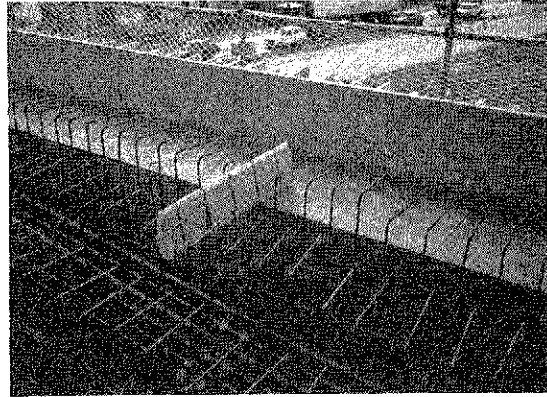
Detalle de una de las cuñas de losa inferior en la 1.ª fase de hormigonado.
